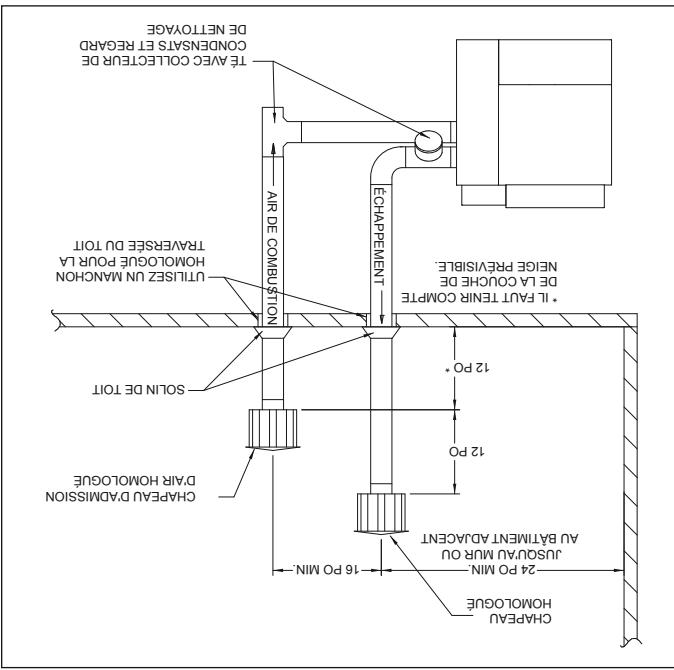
Évacuation verticale - 2 tuyaux, toit en plat
